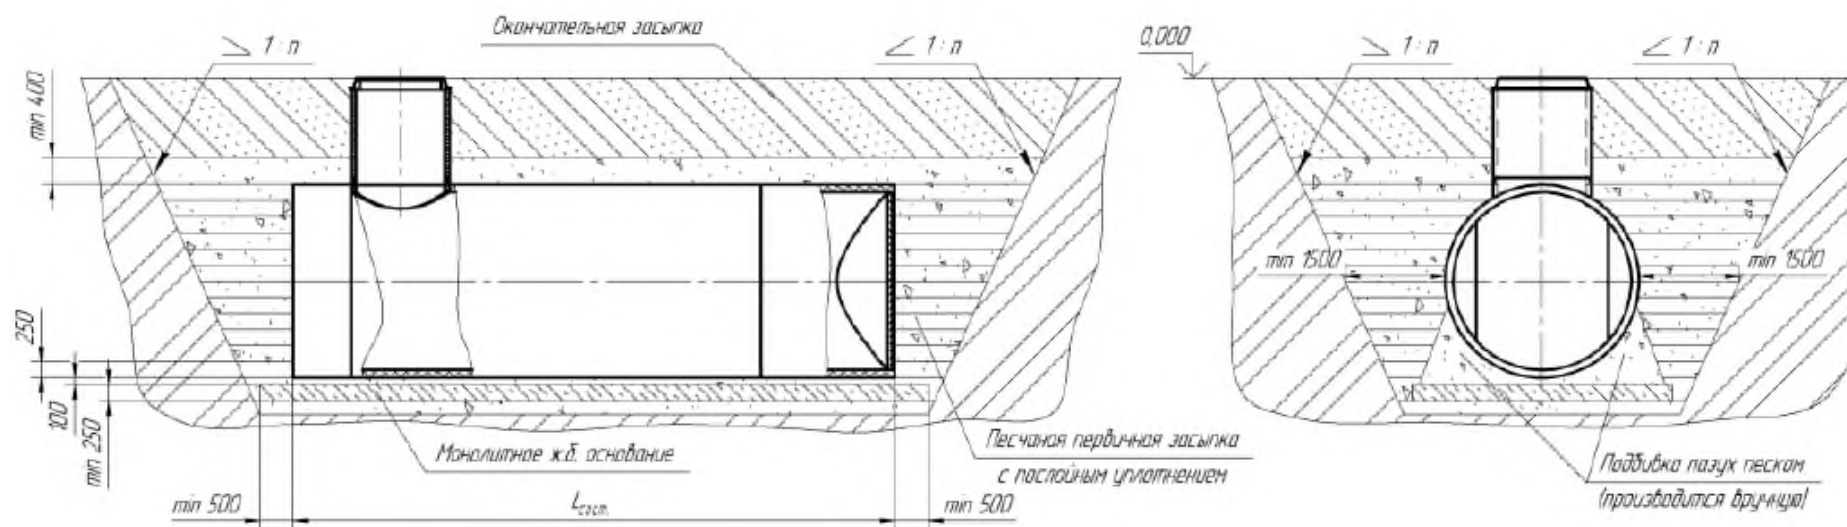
Вариант №2 (монтаж в сухих грунтах на монолитное железобетонное основание)
